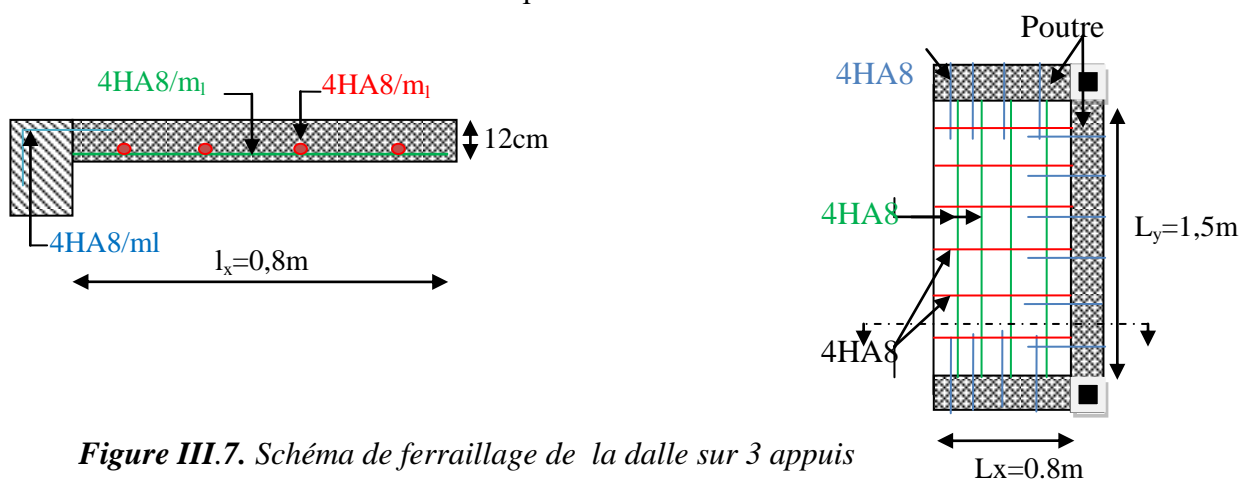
Schéma de ferrailage de la dalle sur 3 appuis
